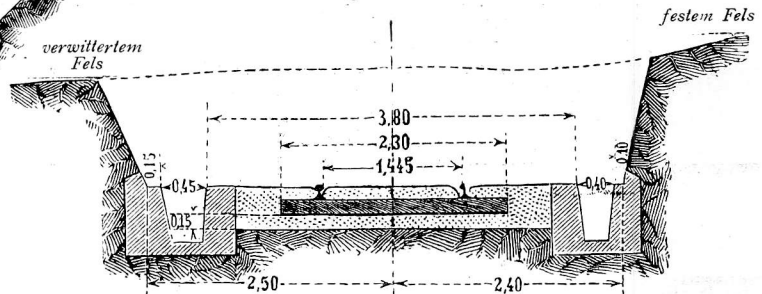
Billige Regelspur I mit Fahrzeugen der Hauptbahnen. Eingeschränkter Einschnitt in
